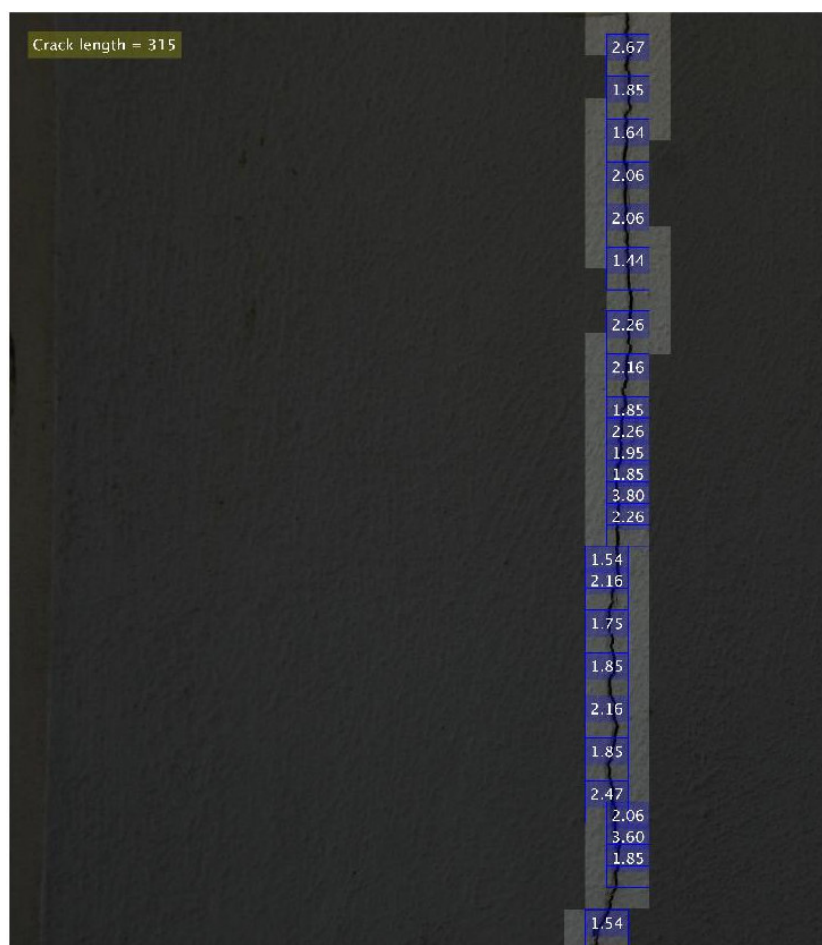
Detecção e caracterização da Fissura 2
